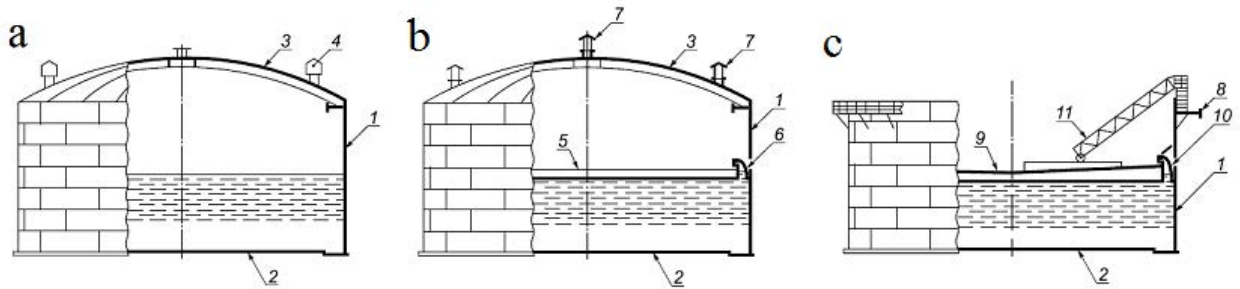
Схемы стальных цилиндрических резервуаров [5]:
